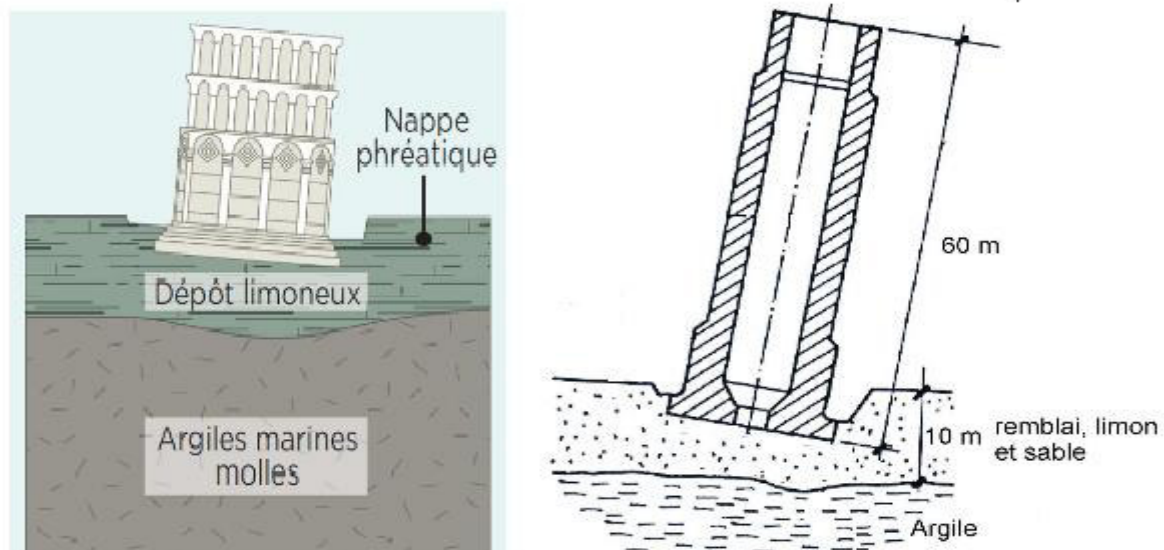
coupe en élévation de la tour de pise et couches de sol.
